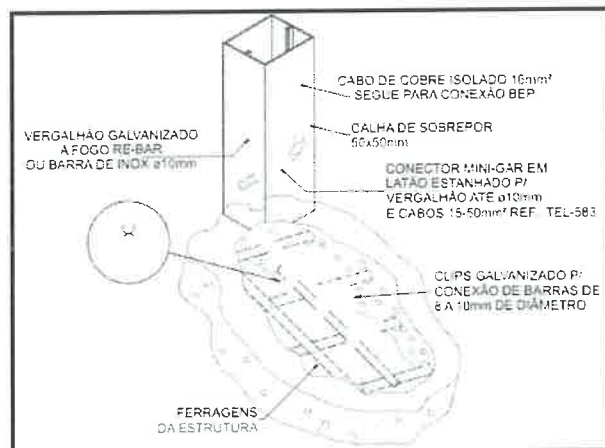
Amarração das ferragens do Radier com vergalhão galvanizado
